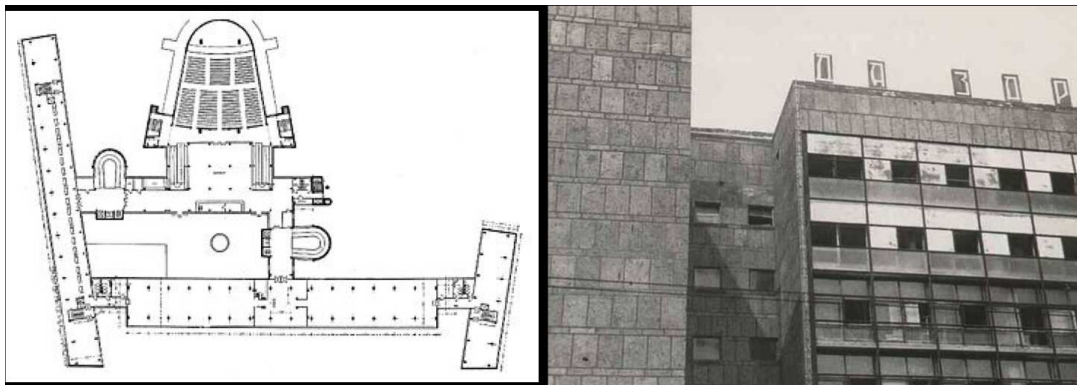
Planta do Tsentrosoyuz Building/ Imagem da fachada
